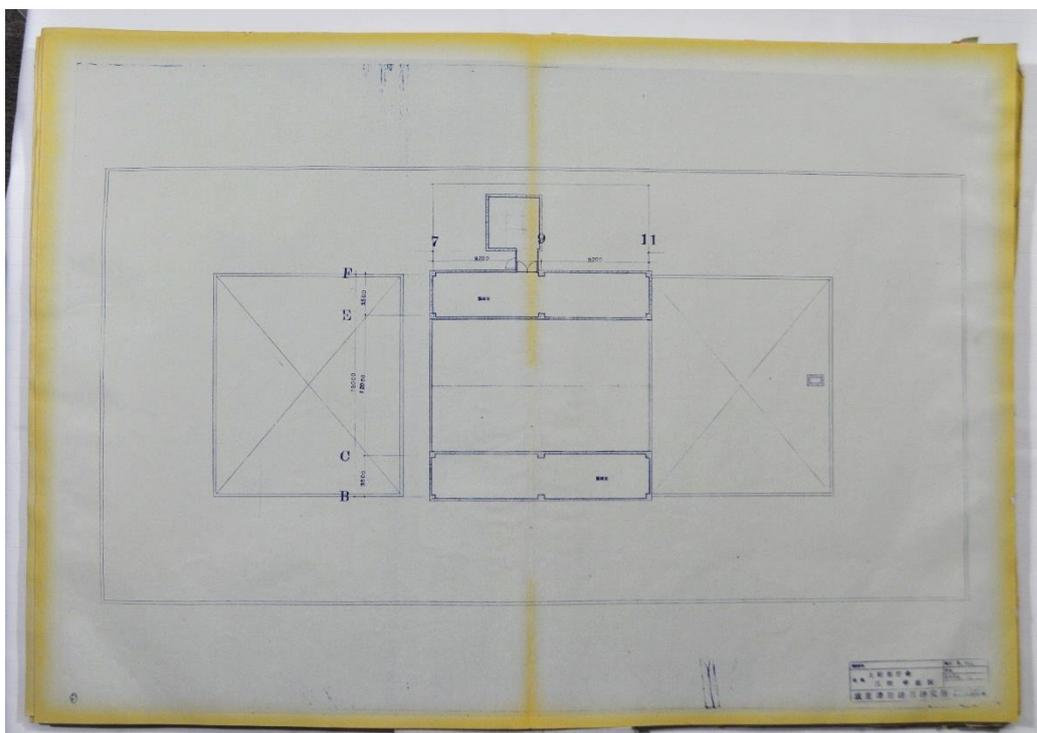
「設計図」上野市庁舎1階平面図 1963年(昭和38)10月8日(1:100)
